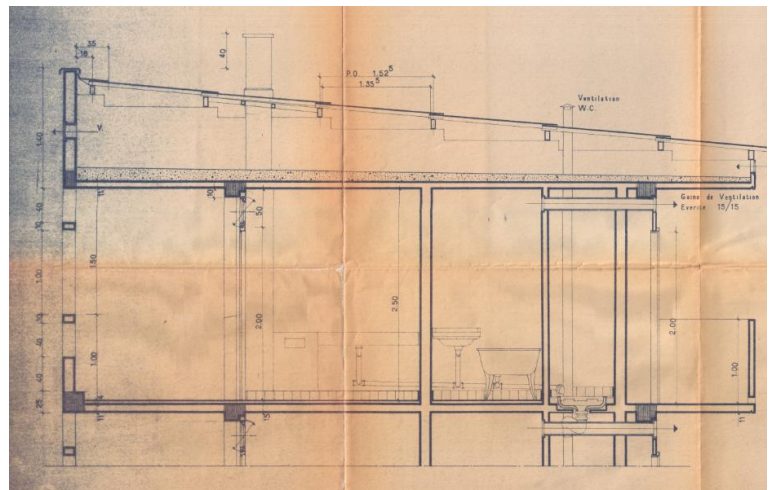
17 Coupe sur un logement collectif, situé en dernier étage détail de la toiture ventilée, Source archives APC Biskra.
